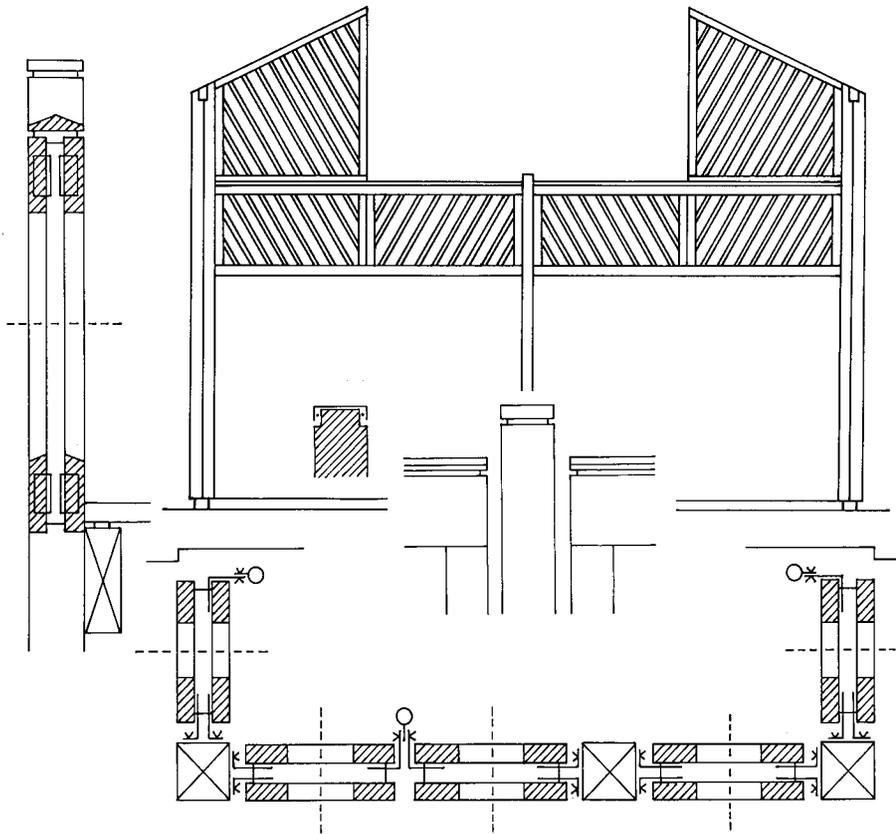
Balkon am Intelligenten Haus mit Vertikalschnitt (oben) und Horizontalschnitt (unten)
